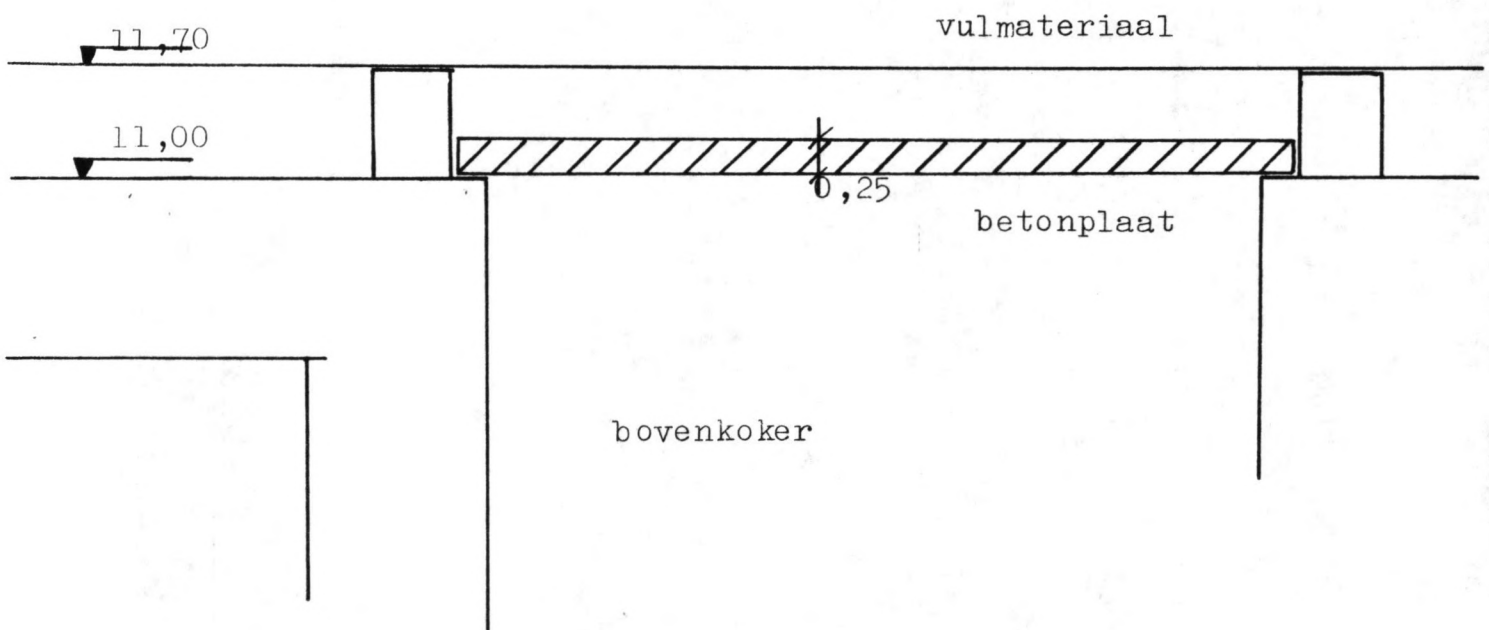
Afdichting bovenkant doorlaatcaisson
